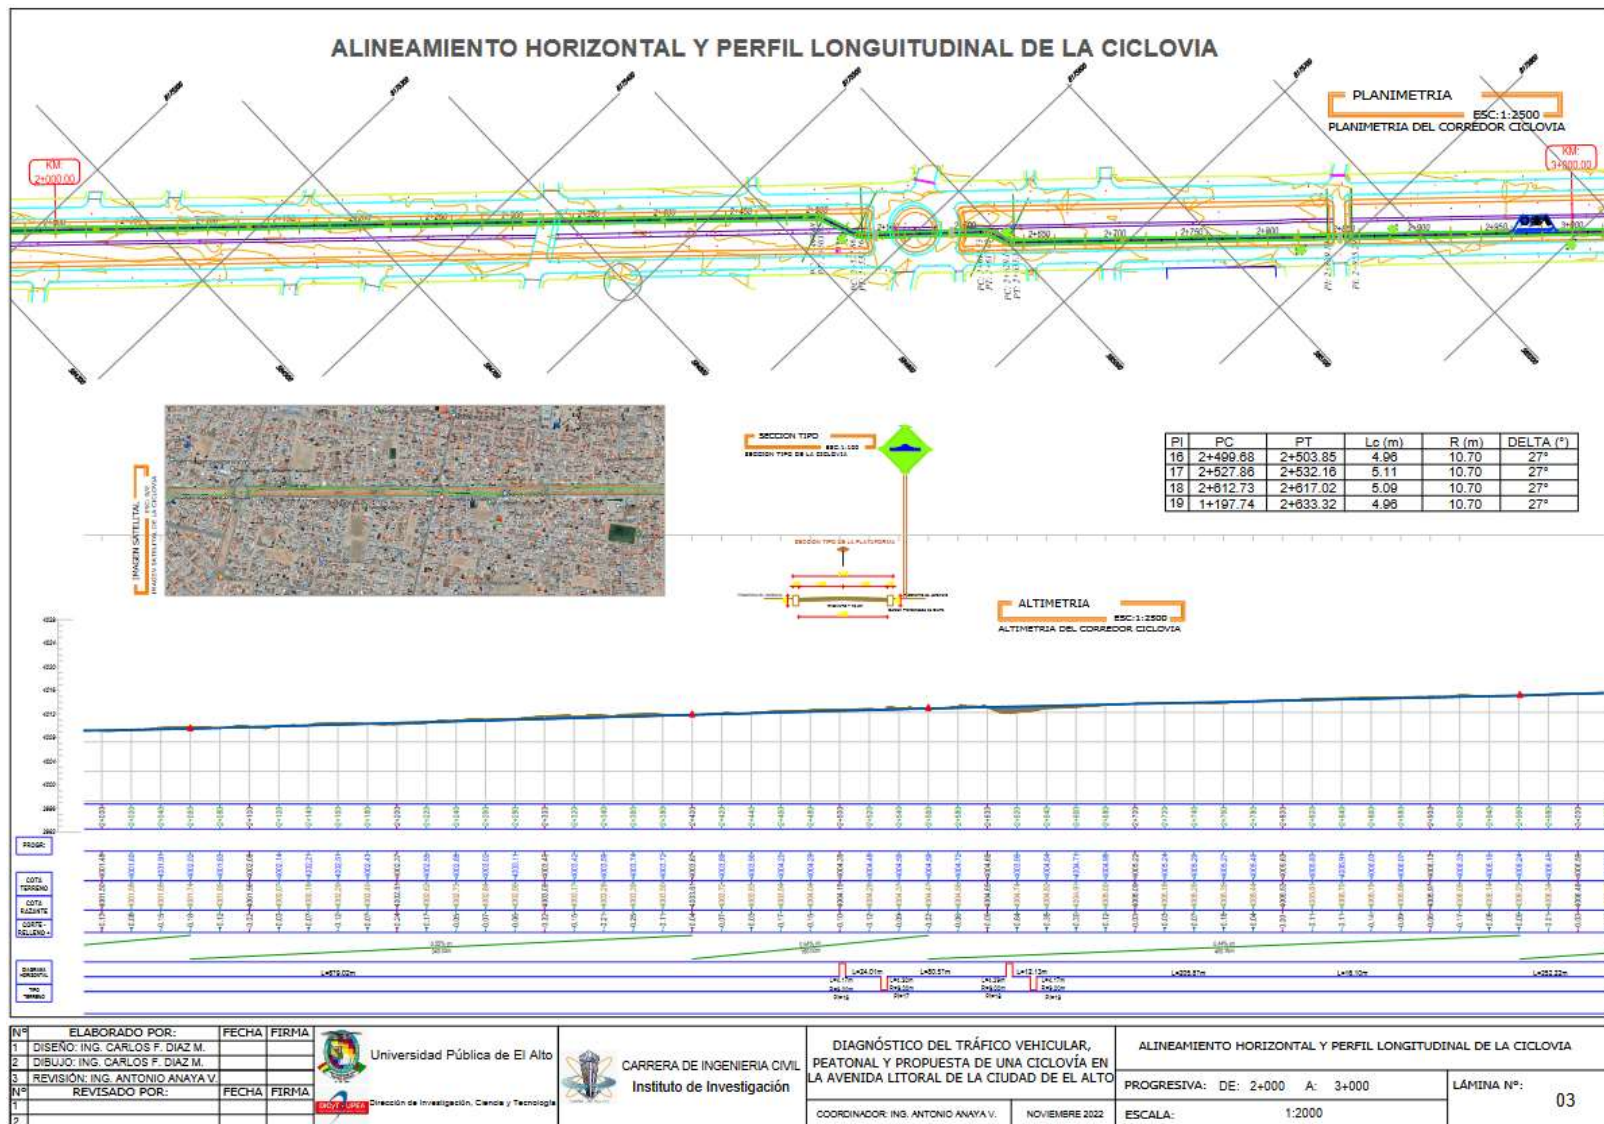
Plano de alineamiento horizontal y perfil longitudinal de la ciclovia (1-8)
